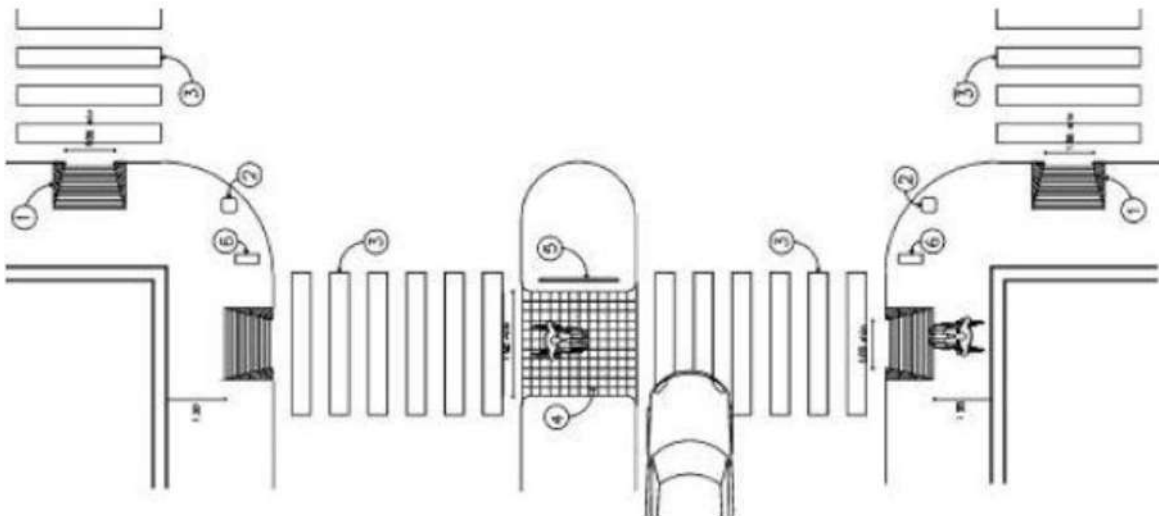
Dimensiones de Cruceros. Fuente: Ibídem
